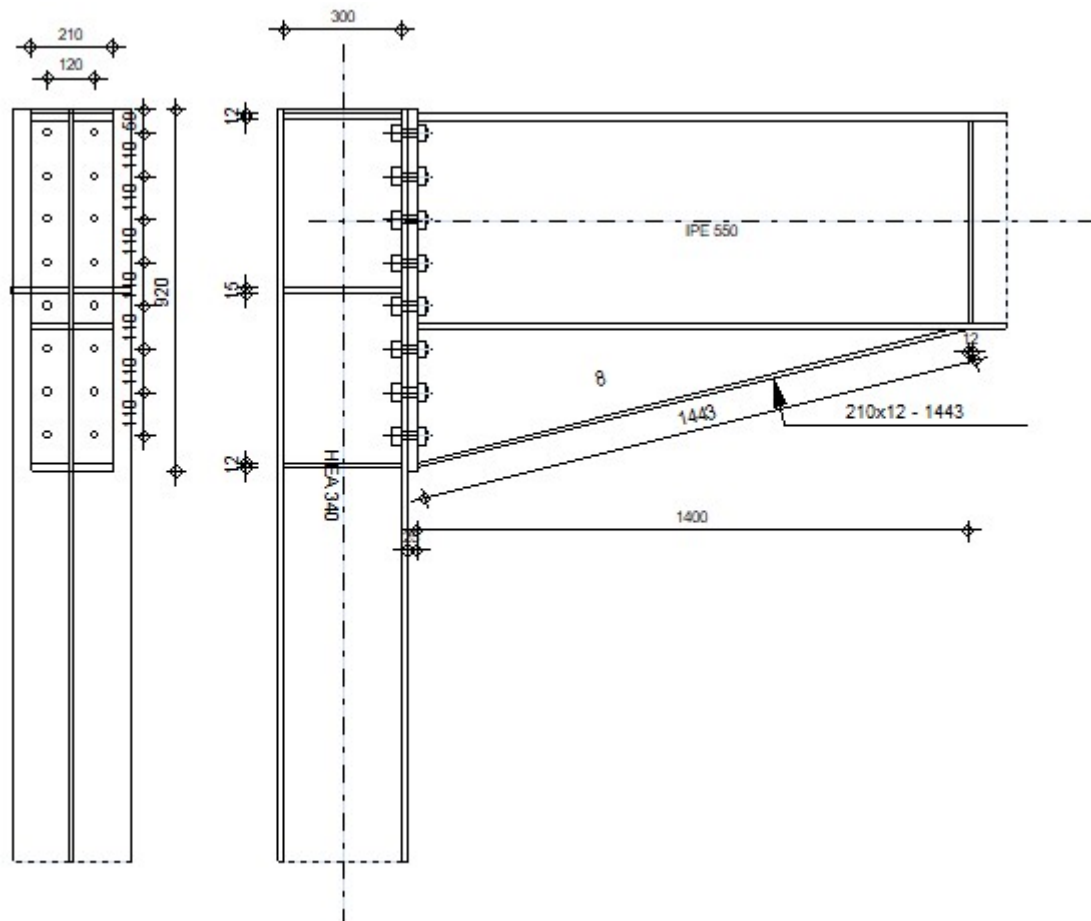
assemblage poteau (HEA 340) avec poutre (IPE550)
